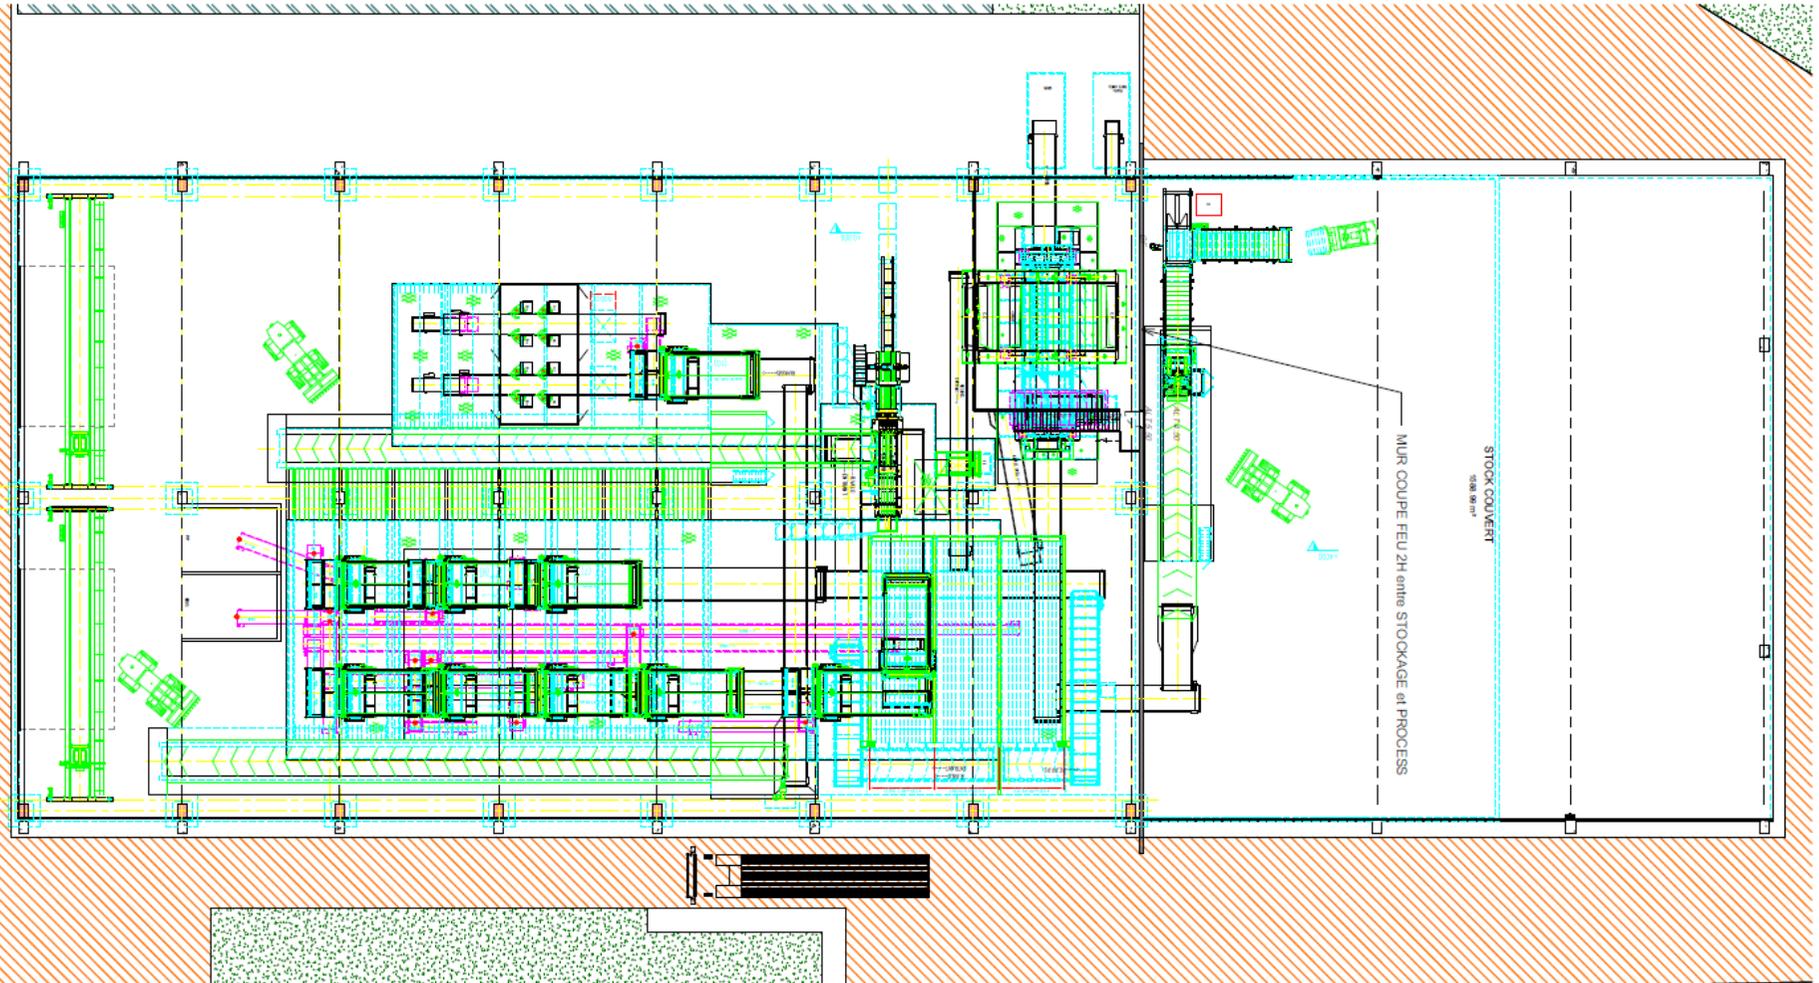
Plan en coupe de la zone process du bâtiment de surtri de l'extension
